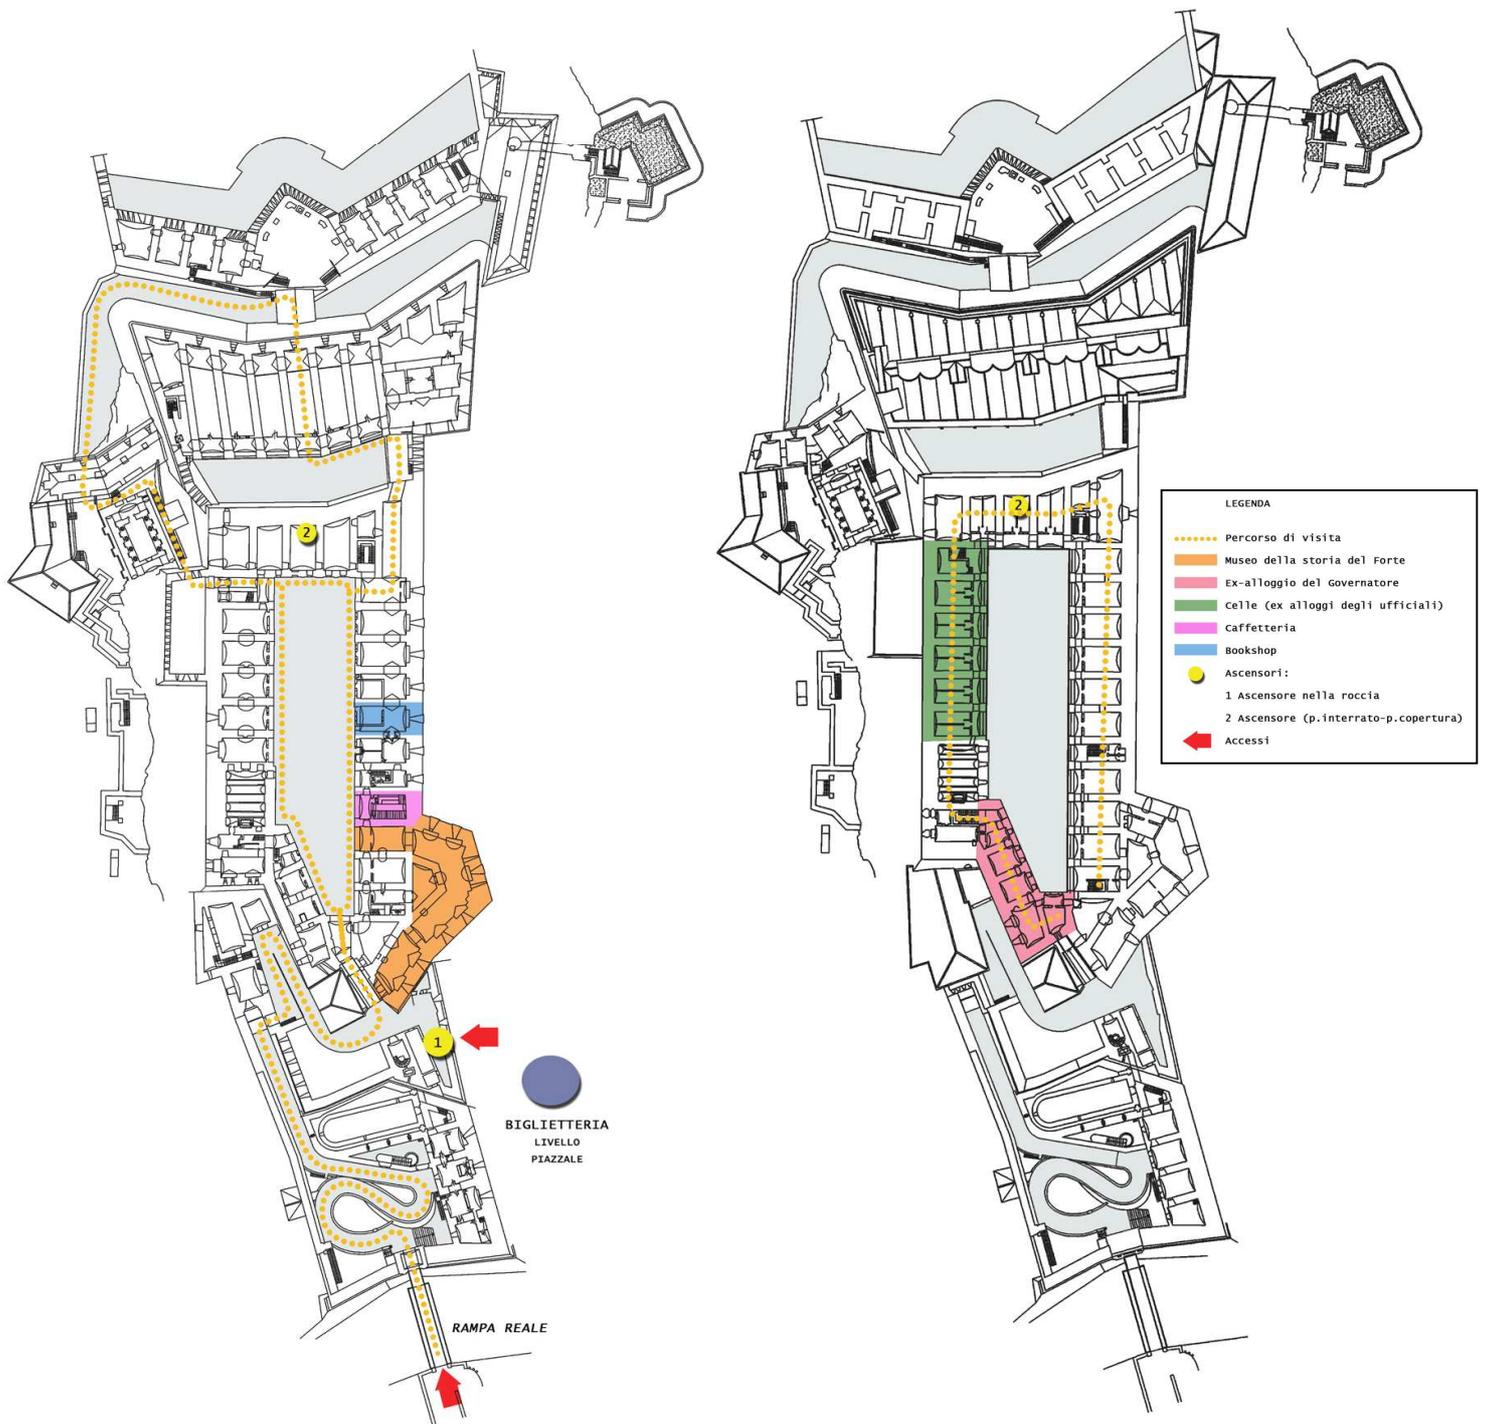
Usi attuali del forte (pianta piano terra e pianta piano primo)
